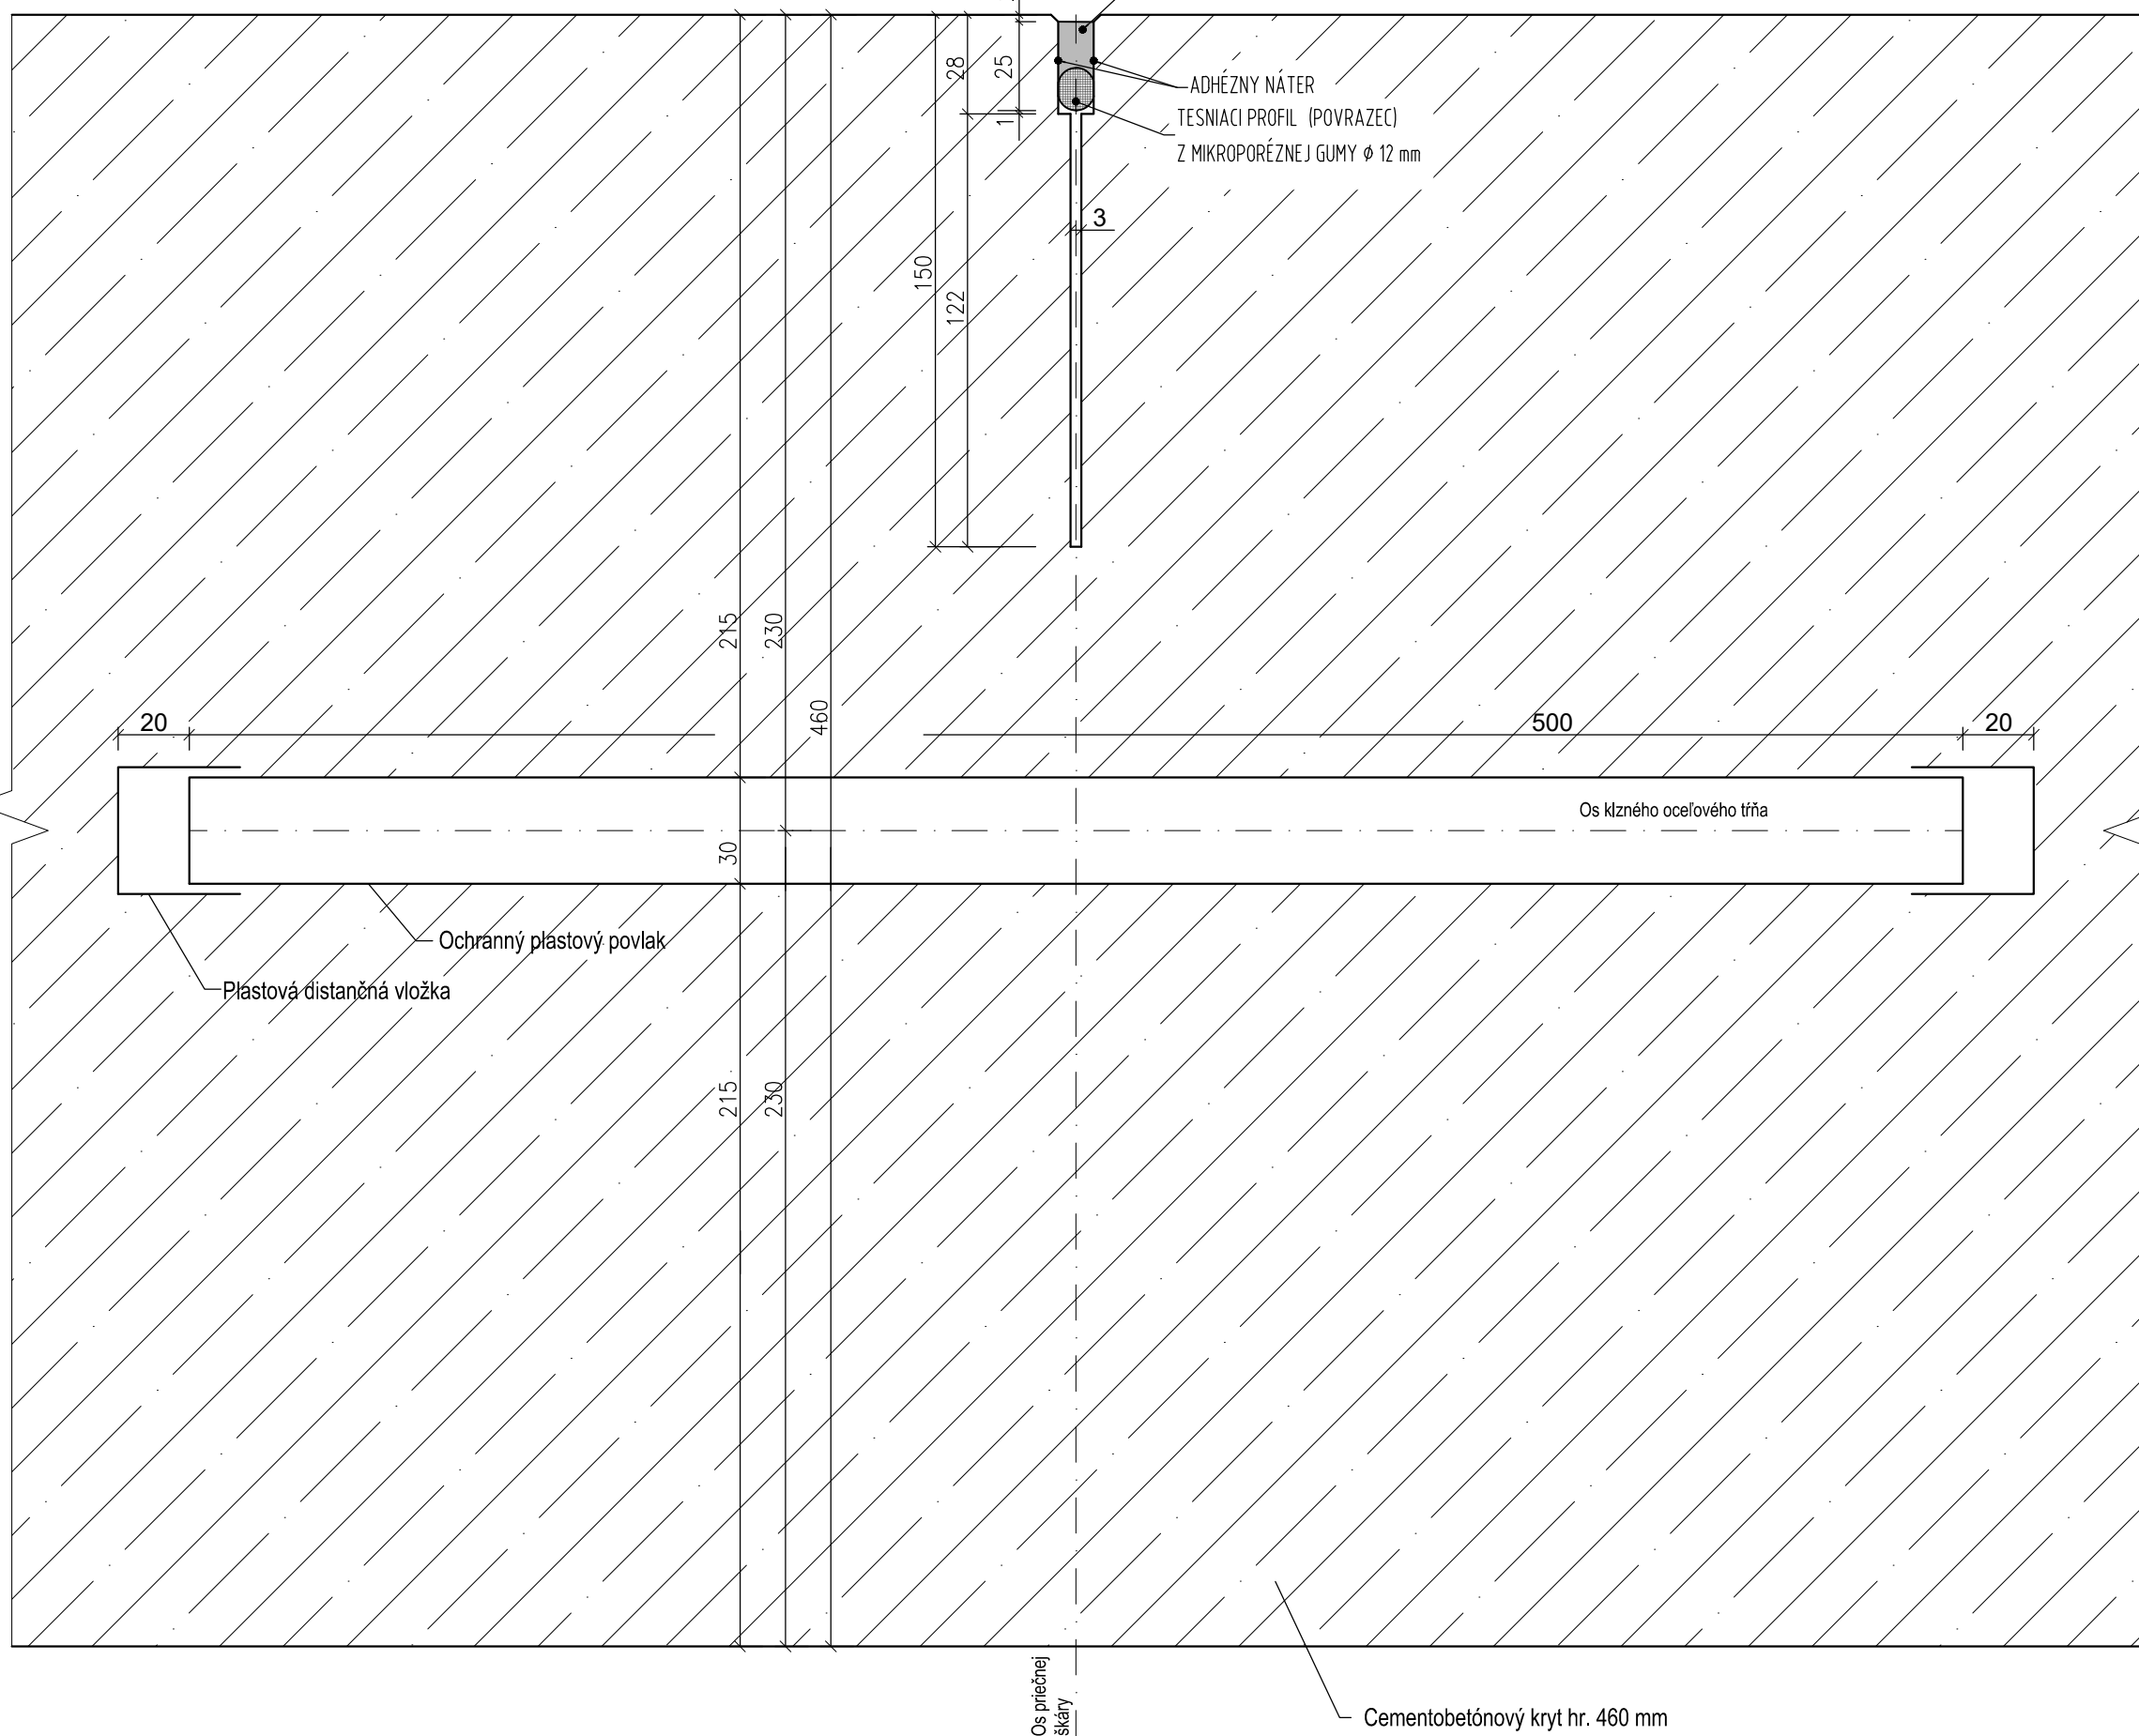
DETAIL PRIEČNEJ ŠKÁRY 1:2 (kótované v mm)
